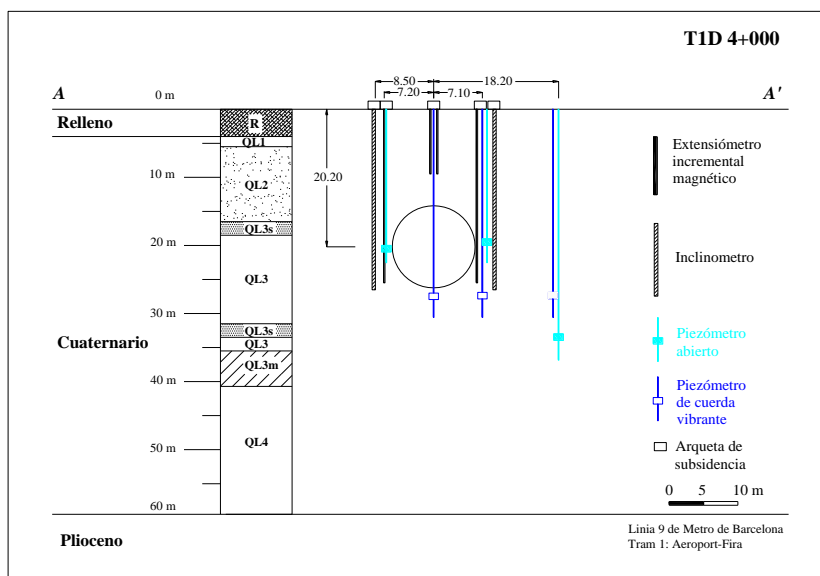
9. Perfil de la instrumentación instalada en la sección de control T1D PK 4+000
